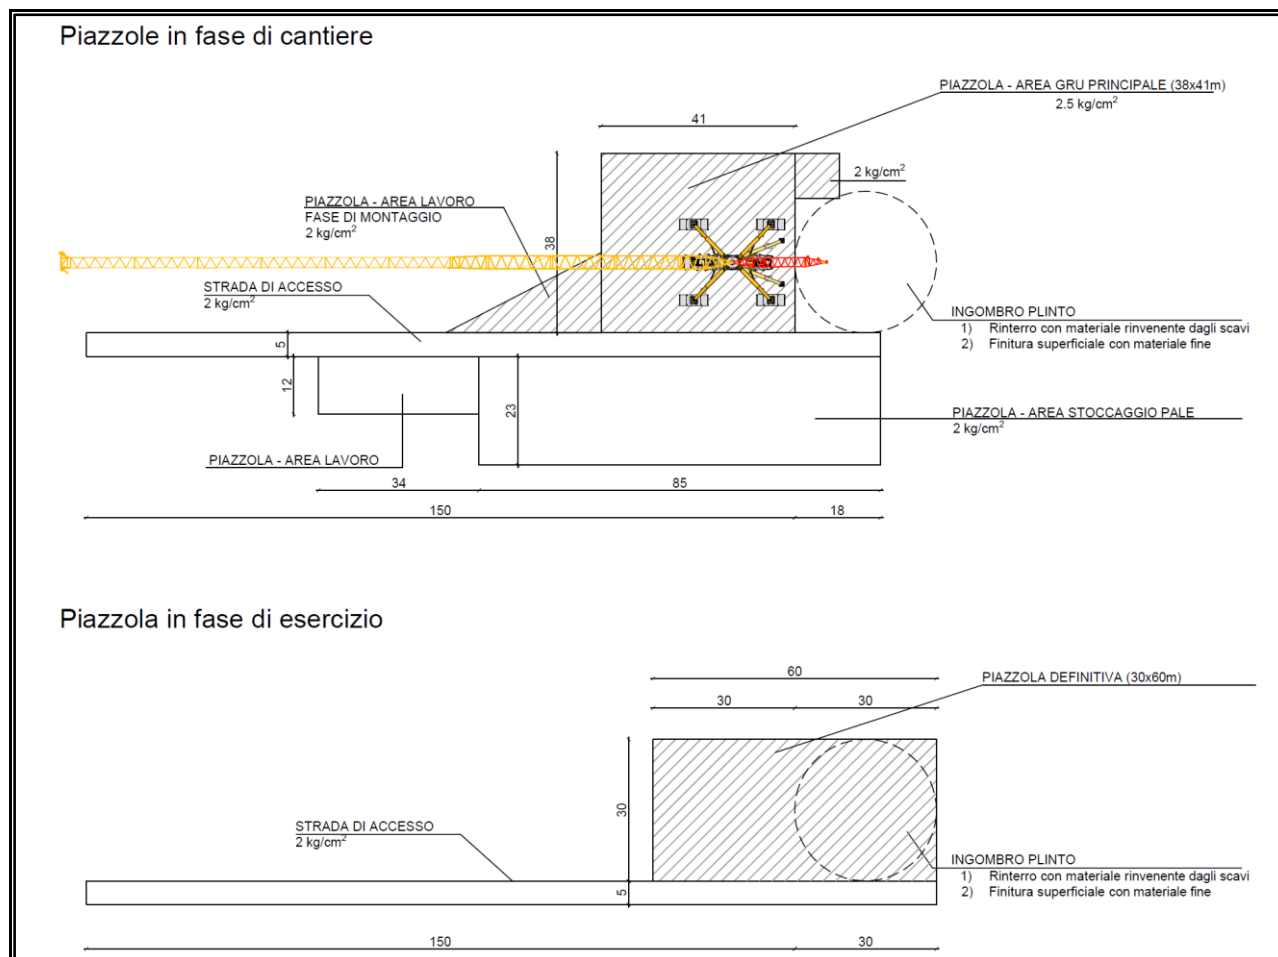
Planimetria piazzola tipo per la fase di installazione e fase di esercizio e manutenzione.
